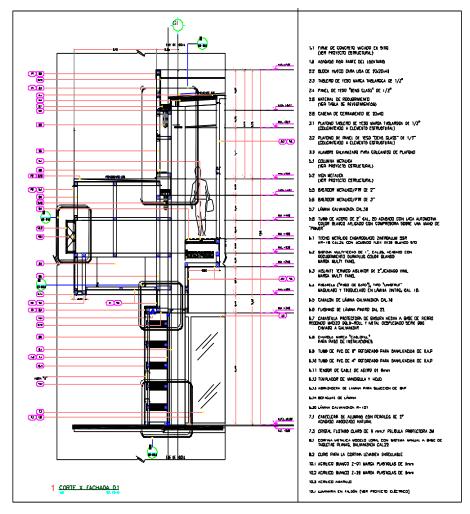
Plano Cortes por fachada cuerpo "G", Referencia Plano: CPJ-CG- 05.DWG
